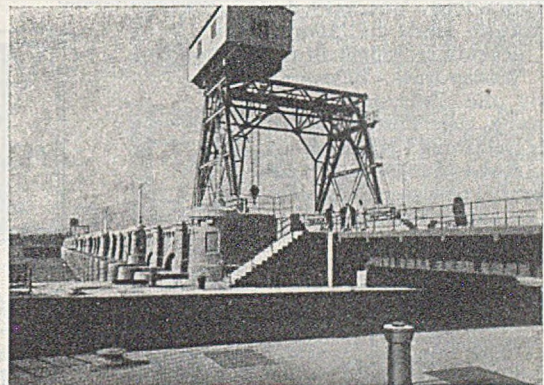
Ansicht des Stauwehres mit dem Portalkran.
